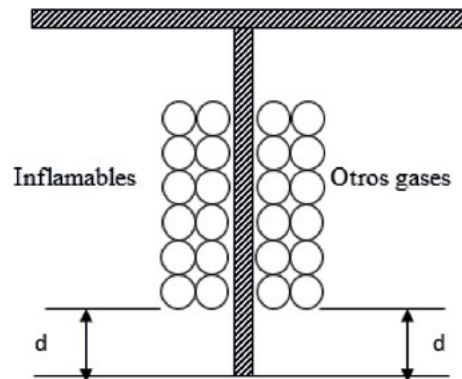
almacenamiento de cilindros con muro adosado a la pared b).
